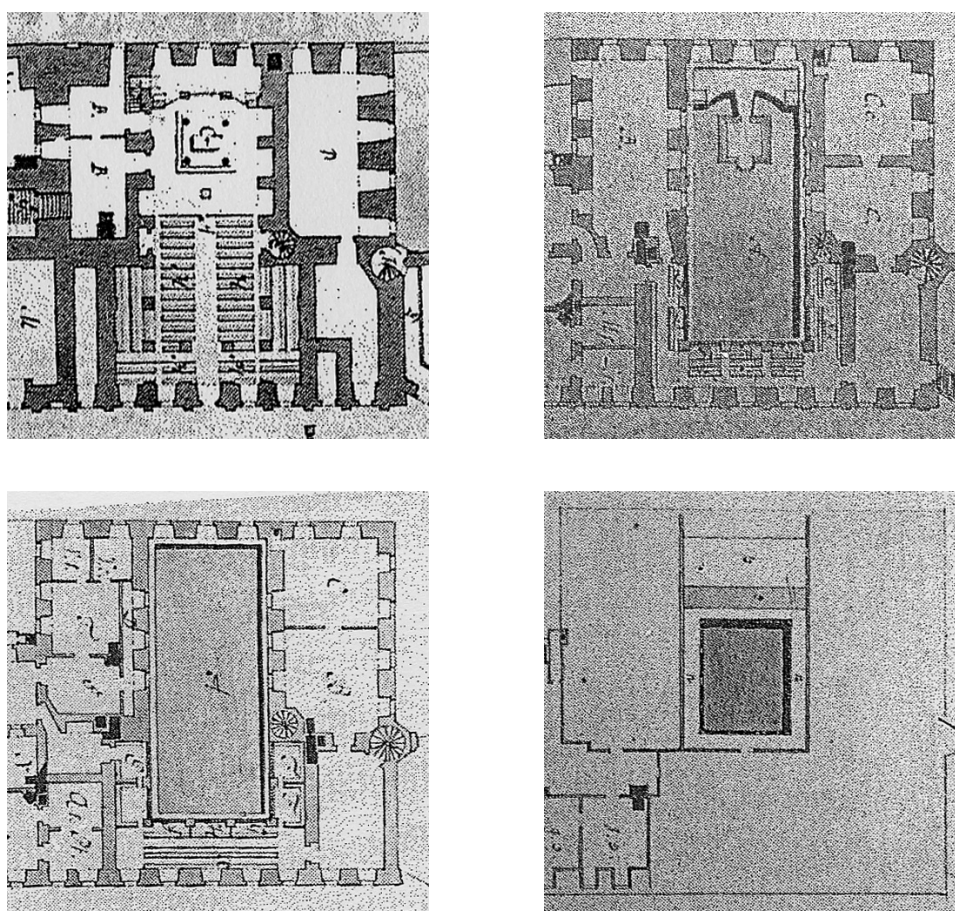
Grundrisse nach Weidner, von oben links nach unten rechts: Erdgeschoss, 1.Obergeschoss, 2.Obergeschoss, Dachgeschoss, um 1750, [Bot 00, S. 122/123]
